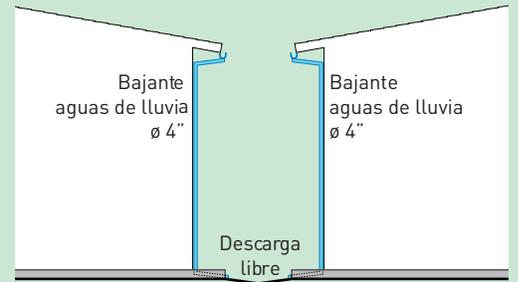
Vista en fachada del bajante de aguas de lluvia
